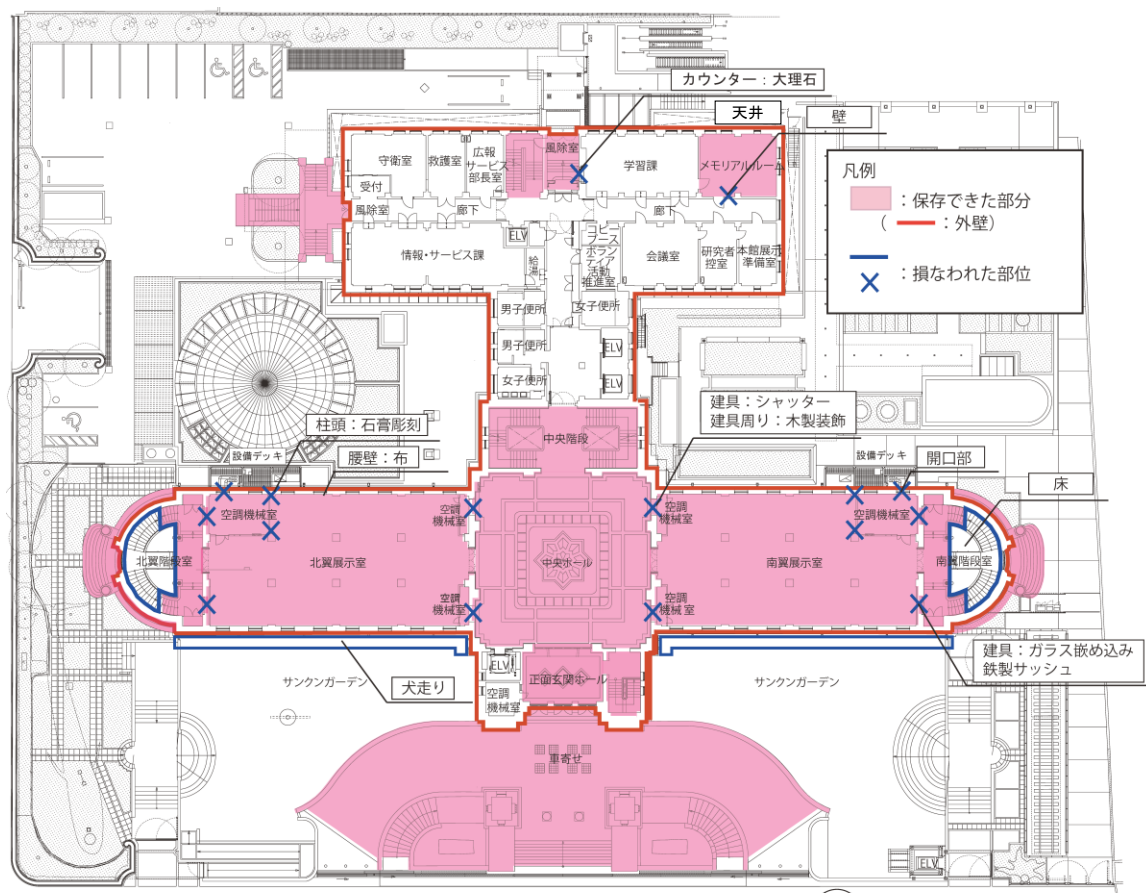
損なわれた文化財的価値 地下1階平面図（改修後地下1階平面図に筆者加筆）
